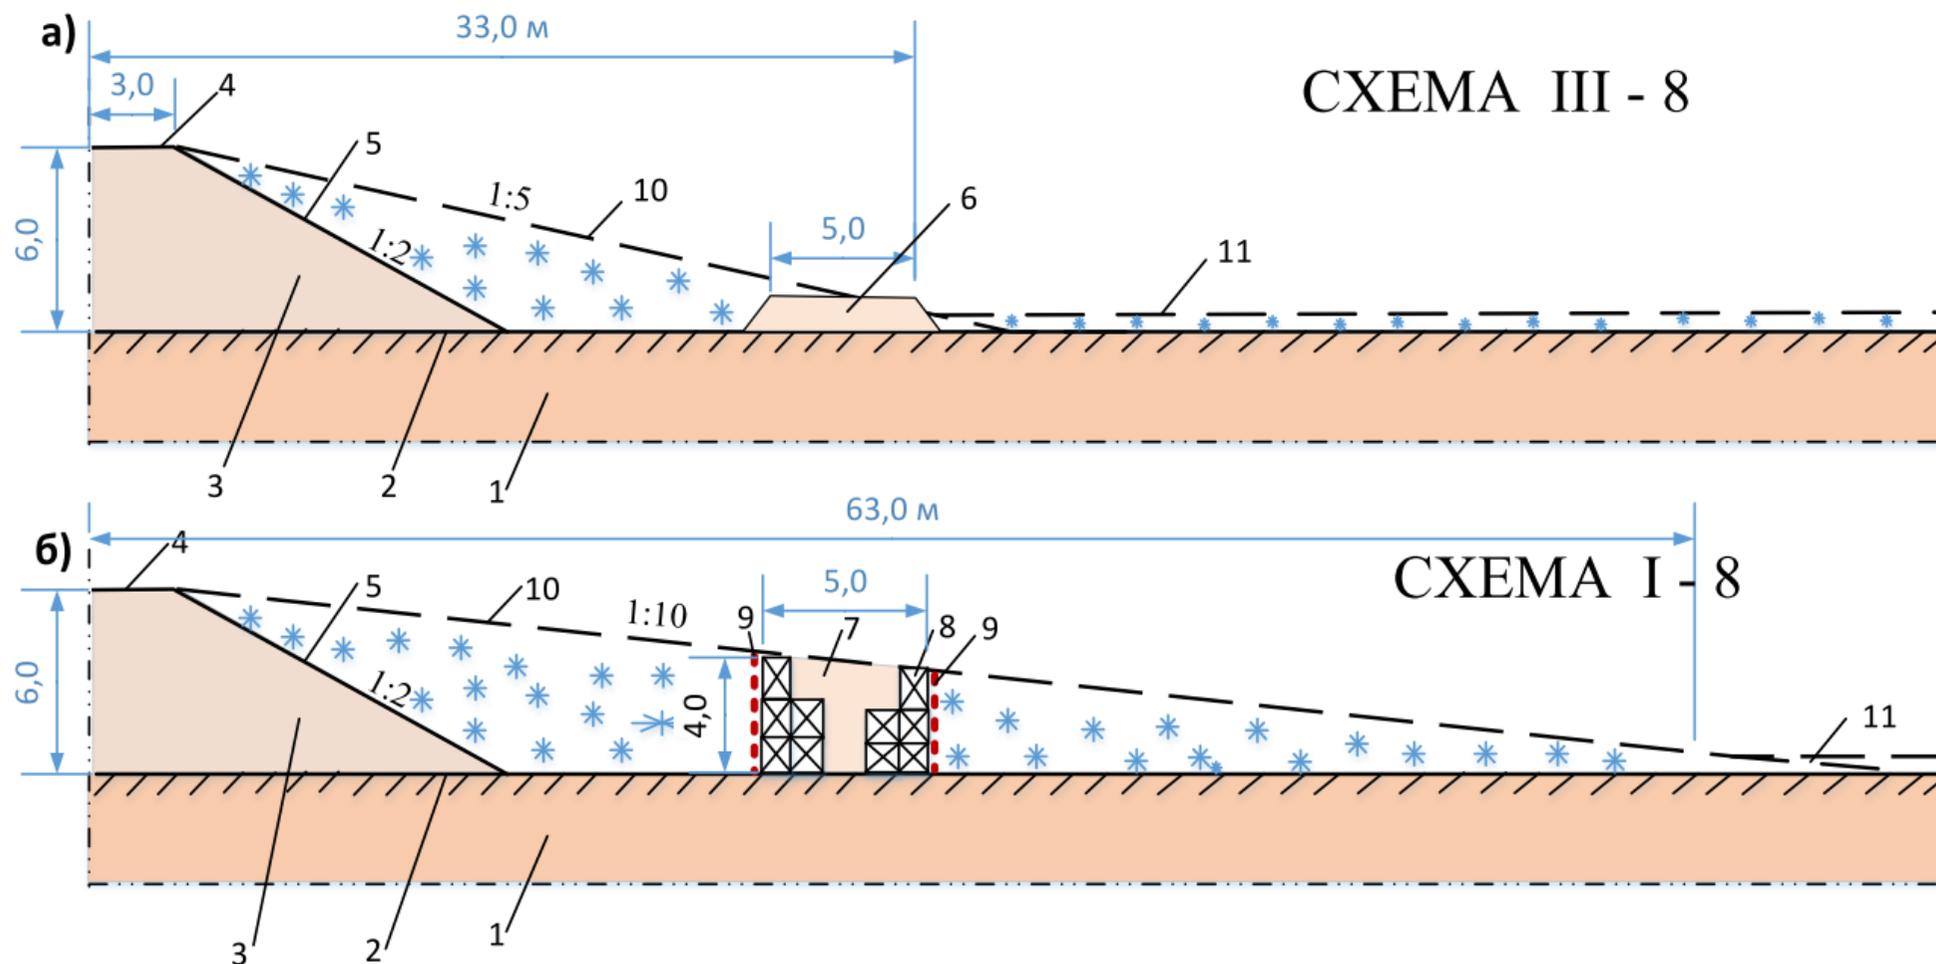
Принципиальные схемы отдельной охлаждающей площадки насыпи: а – отдельная концевая охлаждающая площадка насыпи (ОКП), б – отдельная промежуточная охлаждающая площадка насыпи (ОПП), 1 – грунты основания, 2 – естественная поверхность грунта, 3 – тело насыпи, 4 – основная площадка насыпи, 5 – откос насыпи, 6 – ОКП, 7 – ОПП, 8 - стенка из габионов, 9 – теплоизоляция, 10, 11 – откос снежных отложений соответственно в зоне насыпи и на ненарушенной территории
